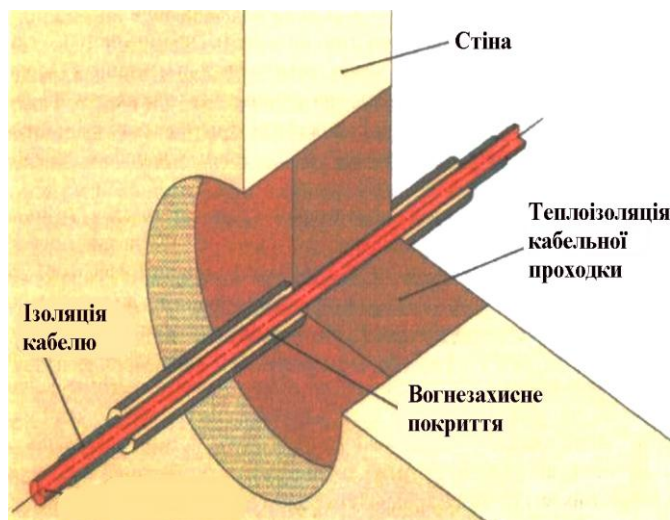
Схема влаштування кабельної проходки крізь огороження
